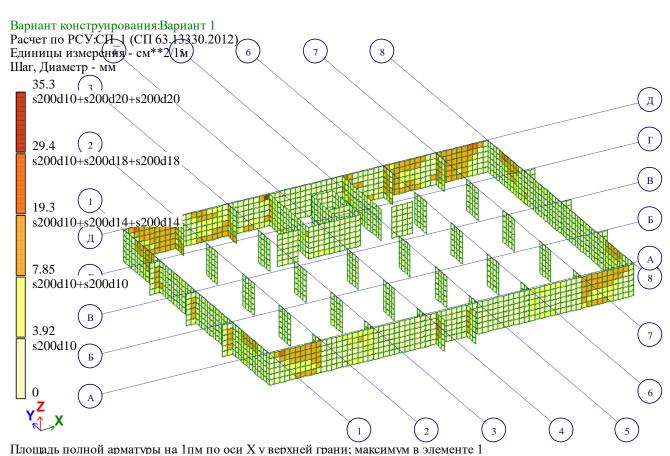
Расчетное армирование стен подвала по оси X у верхней грани.
